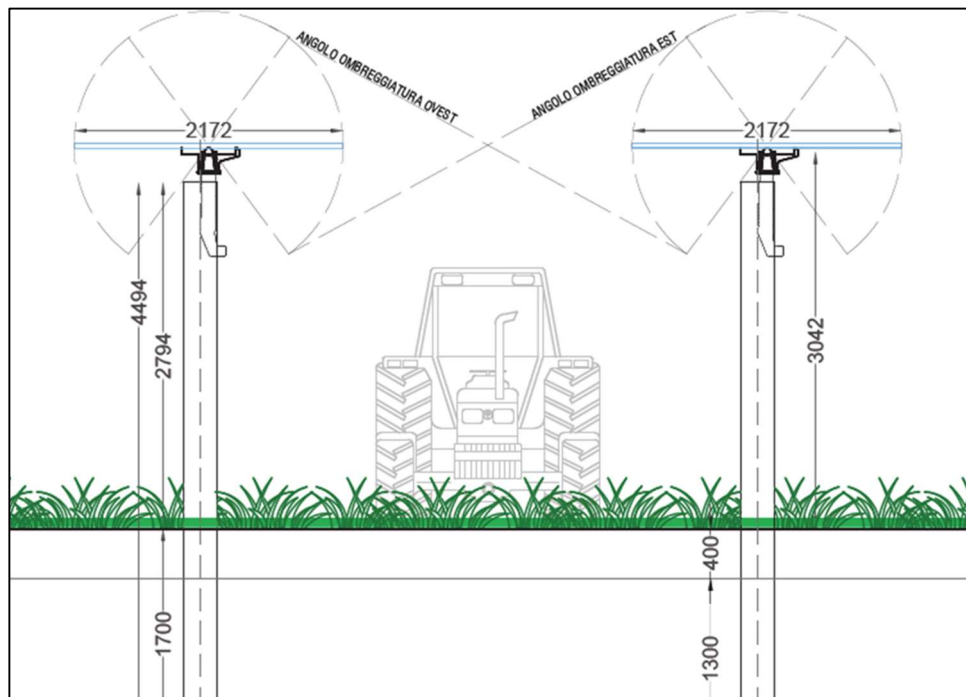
Tipico strutture, trackers, con altezza min dal suolo pari a 2,10 m
